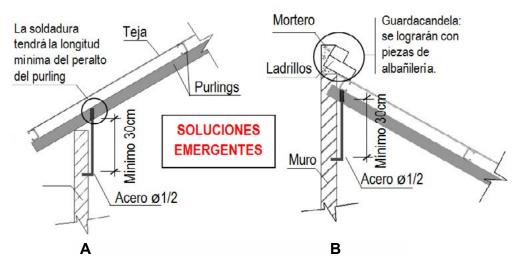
Soluciones emergentes de anclaje: A) Anclaje del purling al muro – B) Anclaje del purling con inserción en el muro
